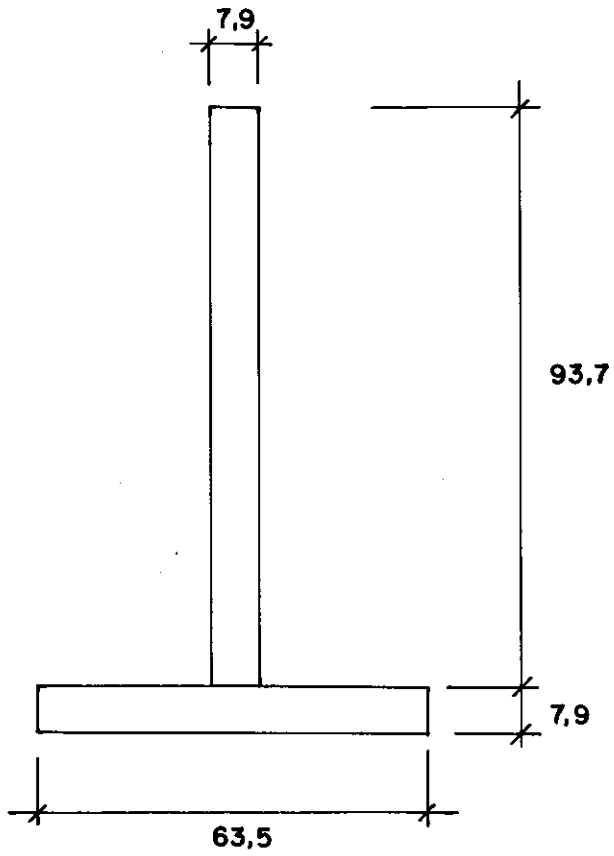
Vista da ligação do montante principal com a travessa de pião.
